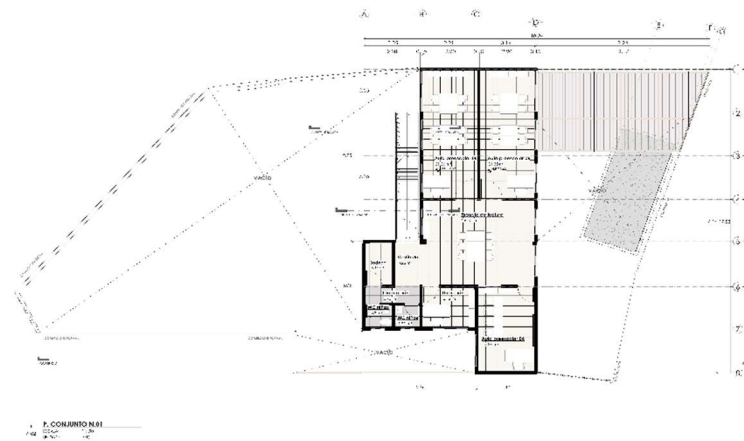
Planta primer nivel CENDI. Elaboración propia
